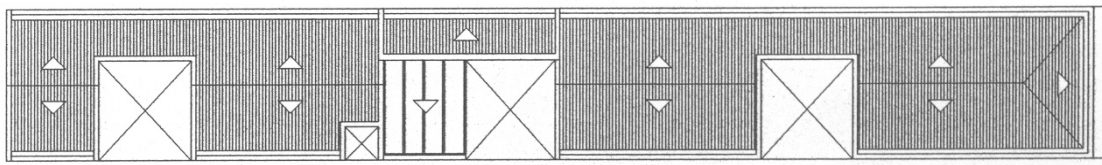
Rua do Livramento, 145 – Planta de cobertura (SECRETARIA, 2000, p. 52).
